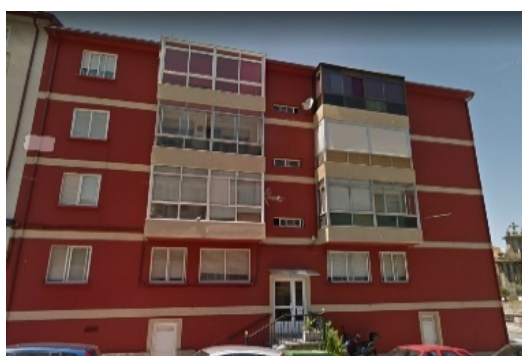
Fotografía de la fachada Este (acceso al inmueble) del edificio de la Rúa Vilagarcía-Arousa, 6 (autoría propia)
